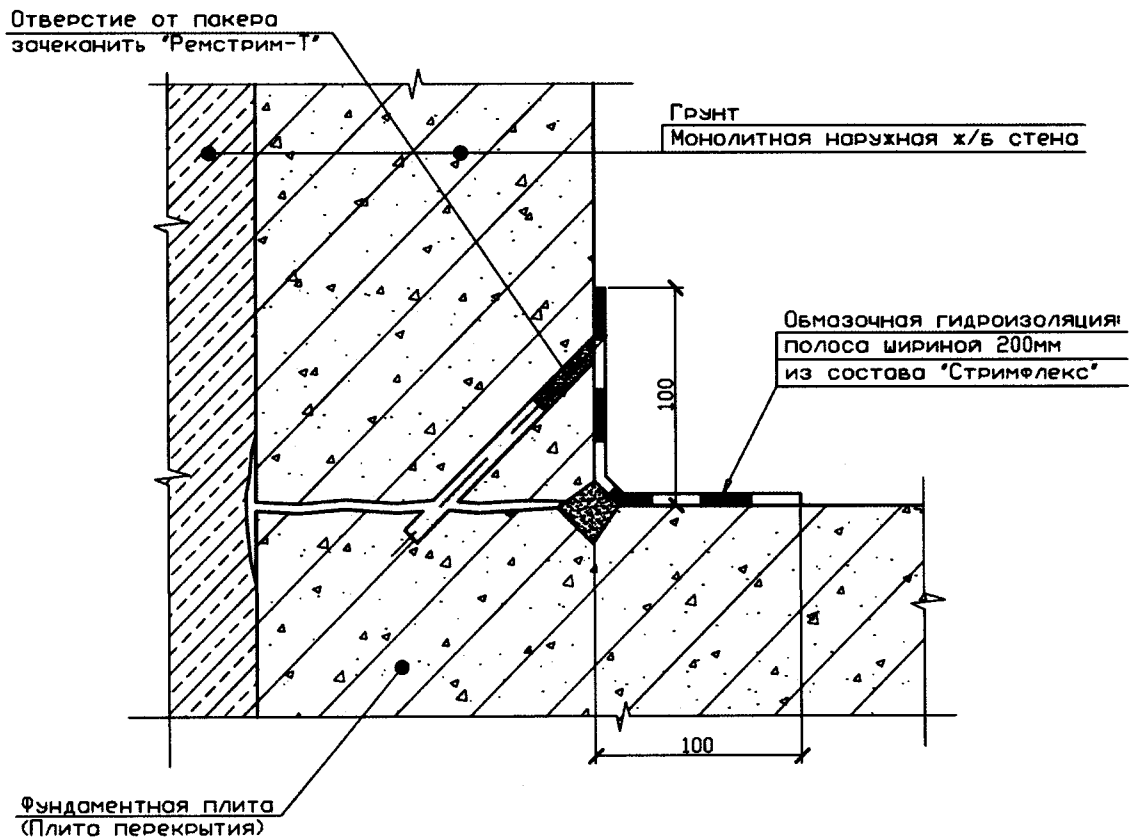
Герметизация конструктивных швов примыкания: «фундаментная плита-наружная стена», «плита перекрытия-наружная стена». Заделка отверстия от пакера и нанесение обмазочной гидроизоляции
